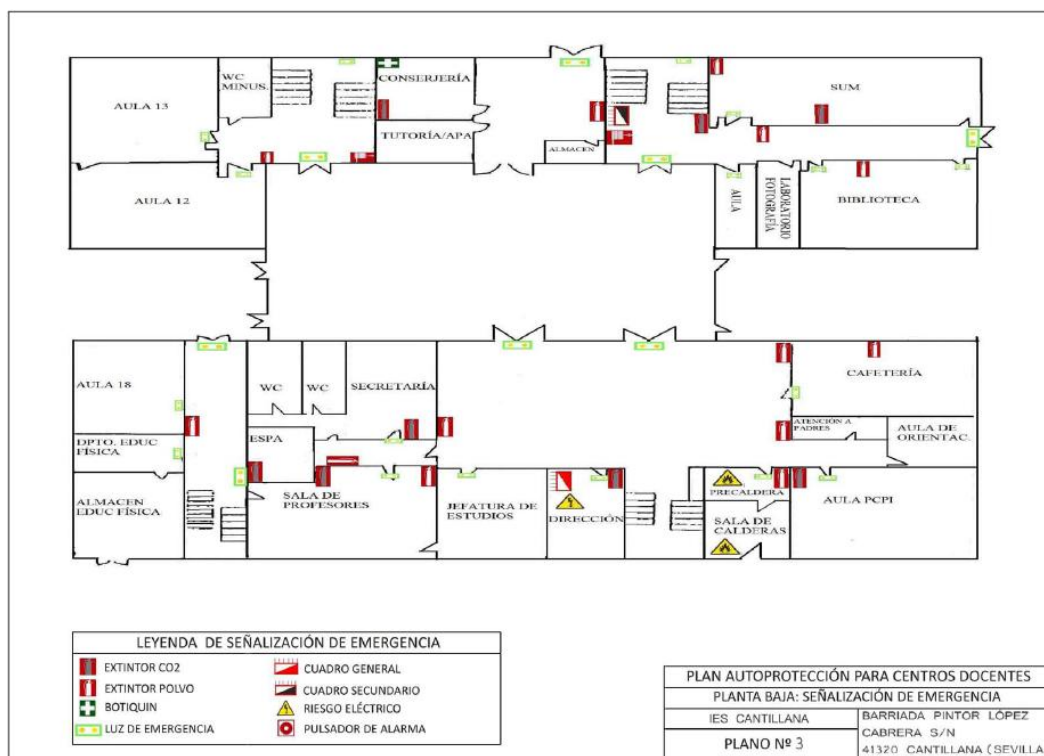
Plano de señalización de emergencia en planta baja de los edificios 1 y 2 del IES Cantillana.
